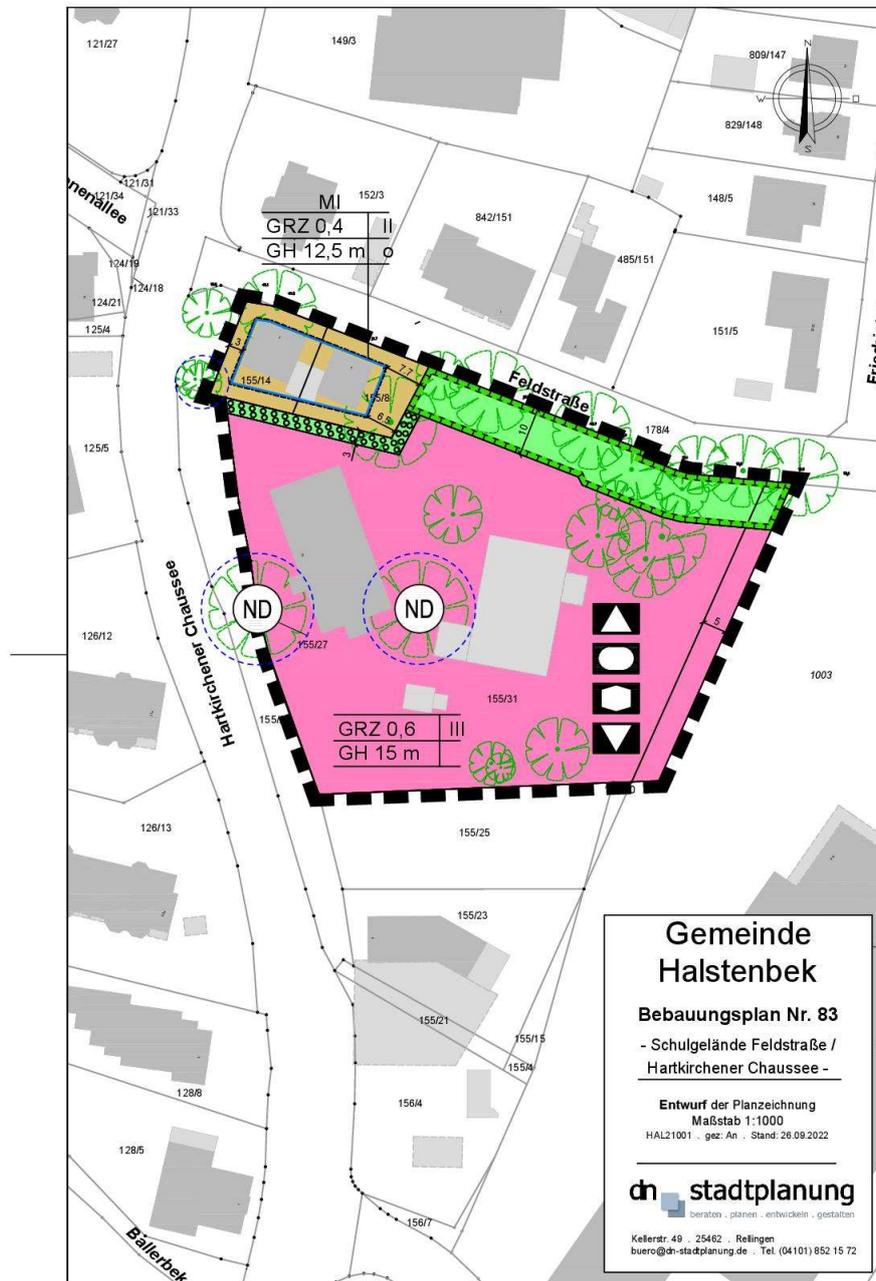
Planzeichnung zum Bebauungsplan Nr. 83 der Gemeinde Halstenbek (DN STADTPLANUNG, Stand 26.09.2022)
